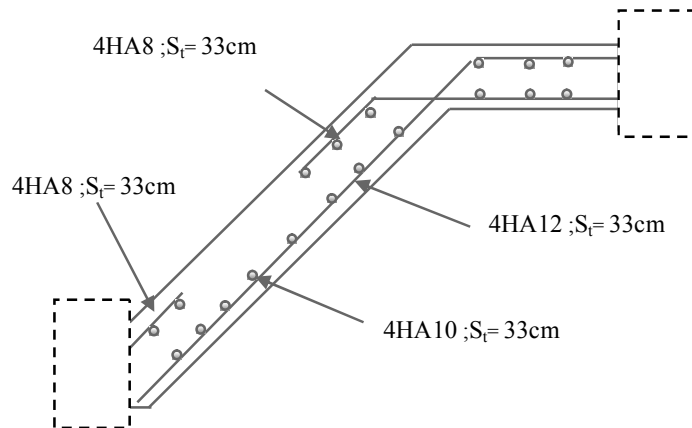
Schéma de ferrailage de l'escalier entre Sol.
